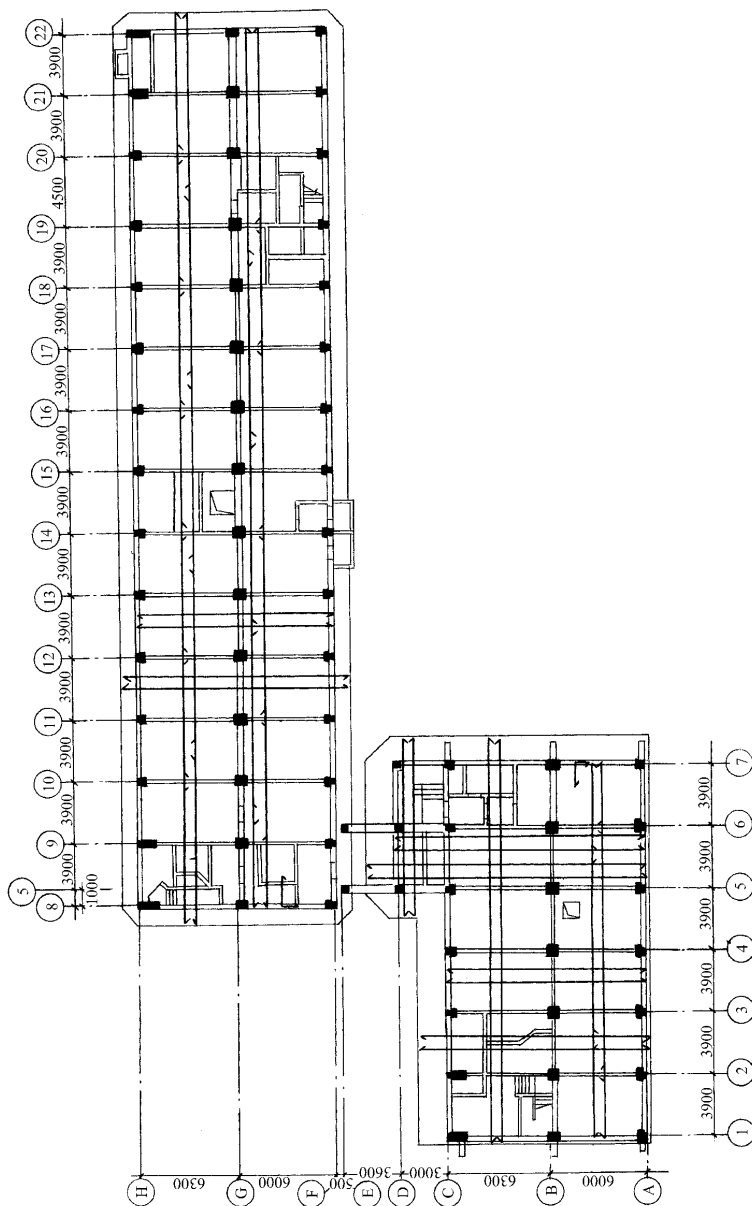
基础结构平面图 (上部为北楼基础平面图)
